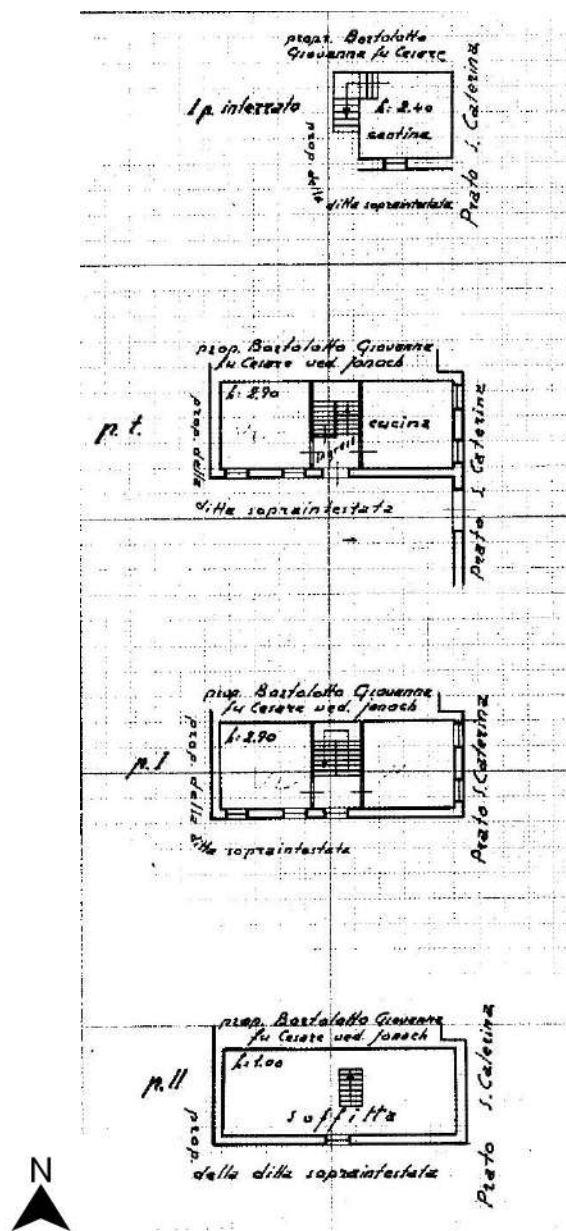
Planimetria catastale P.la 189 abitazione – stato approvato
